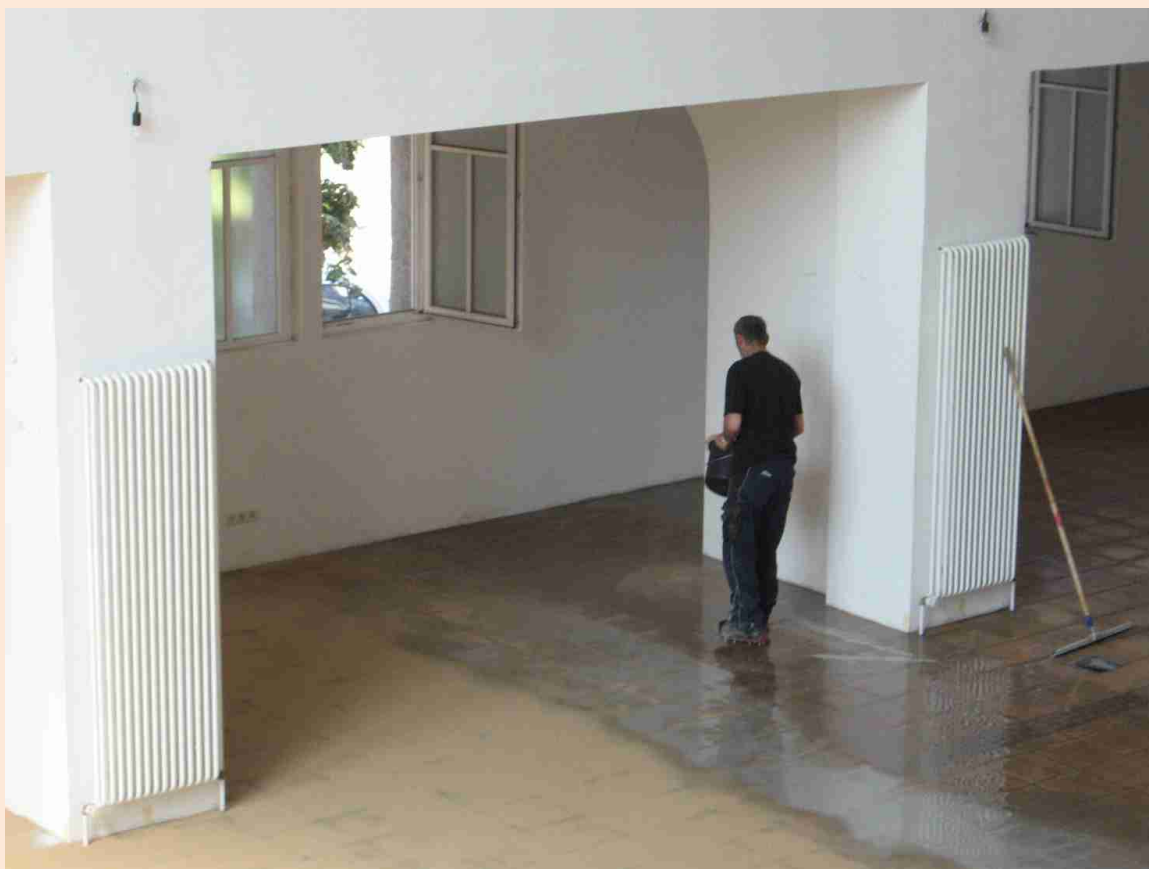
abwerfen der frischen Grundierung mit feinem Quarzsand
